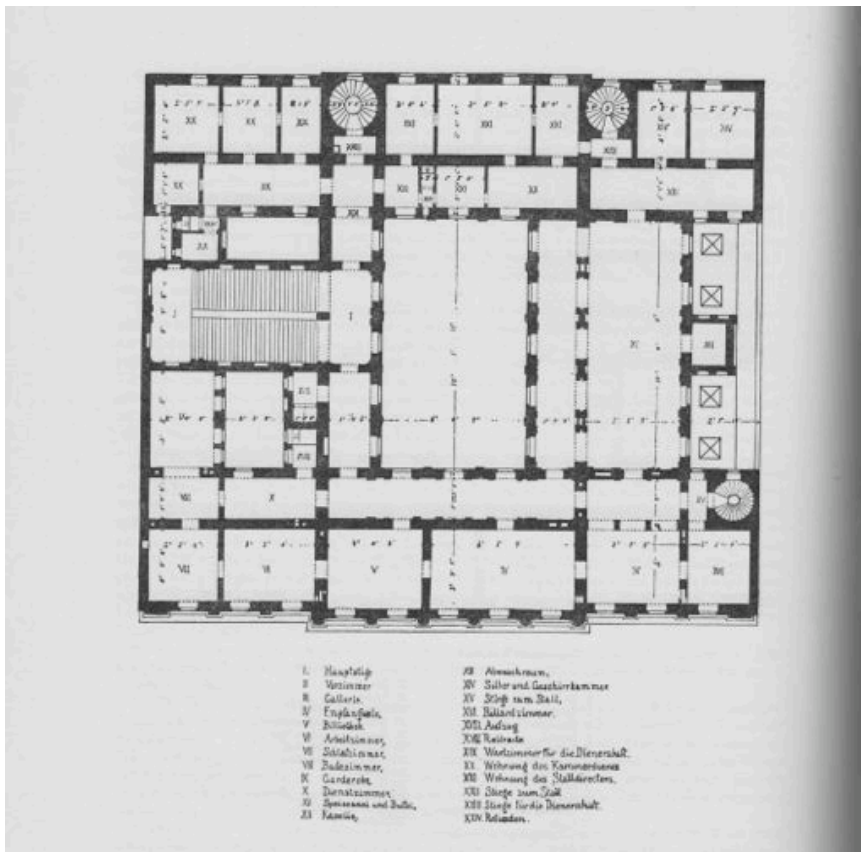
Theophil Hansen, Palais Erzherzog Wilhelm Grundriss 1. Stock, Einreichplan, nach Reissberger.
